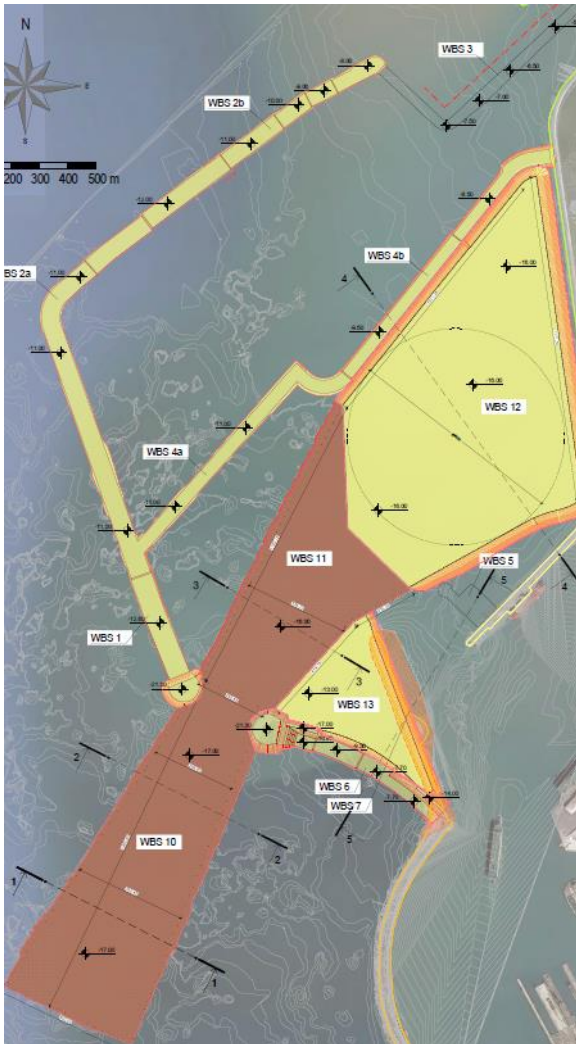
Estratto dalla tavola "Planimetria delle indagini" 1233_PD-E-152
